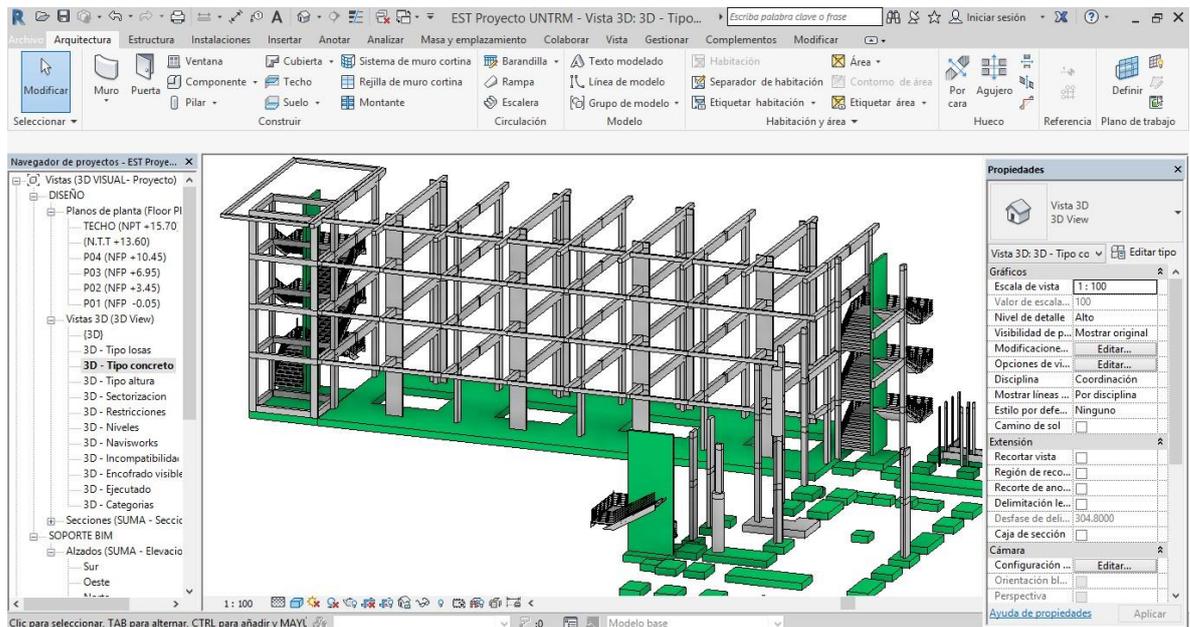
MODELADO EN PLANTA DE CIMENTACION.
